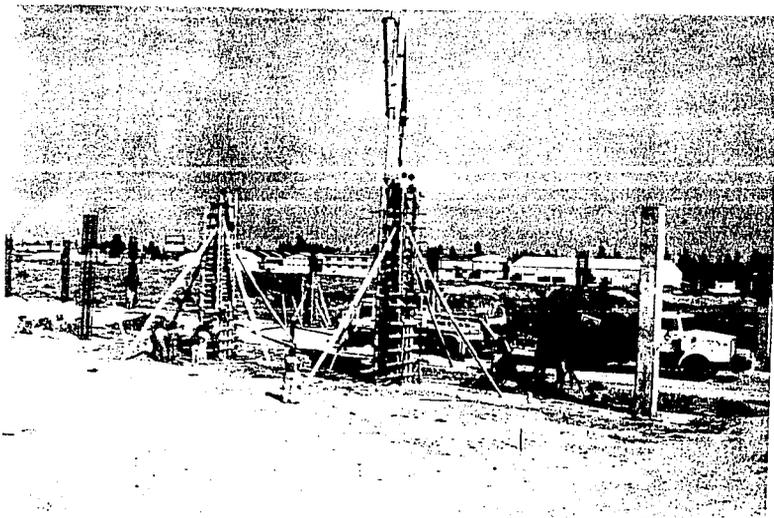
1era. ETAPA DE COLADO DE LAS COLUMNAS PERIMETRALES A UNA ALTURA DE 3.2m; VARILLAS DEL No. 10 ENTERAS
